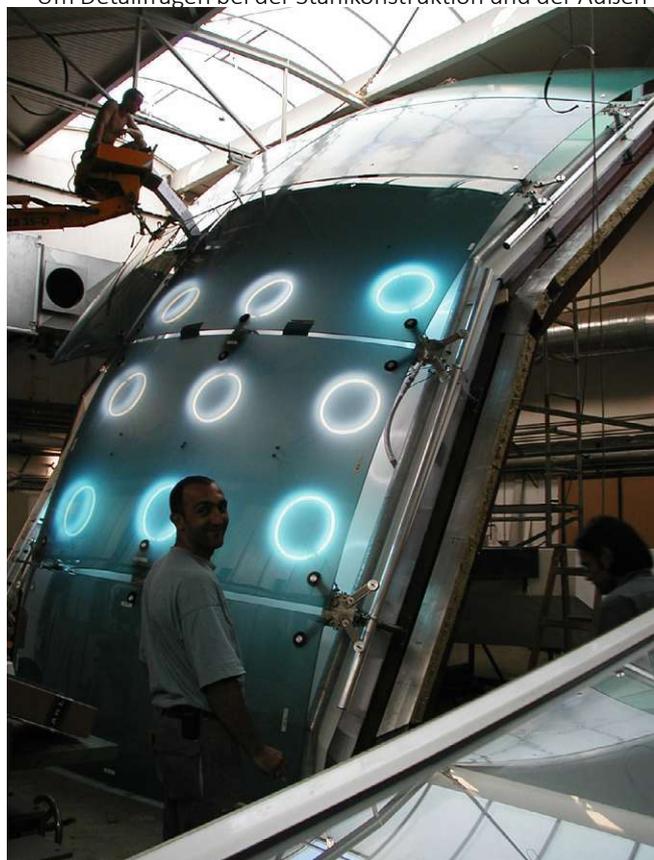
Modell Fassadenausschnitt im Maßstab 1:1
